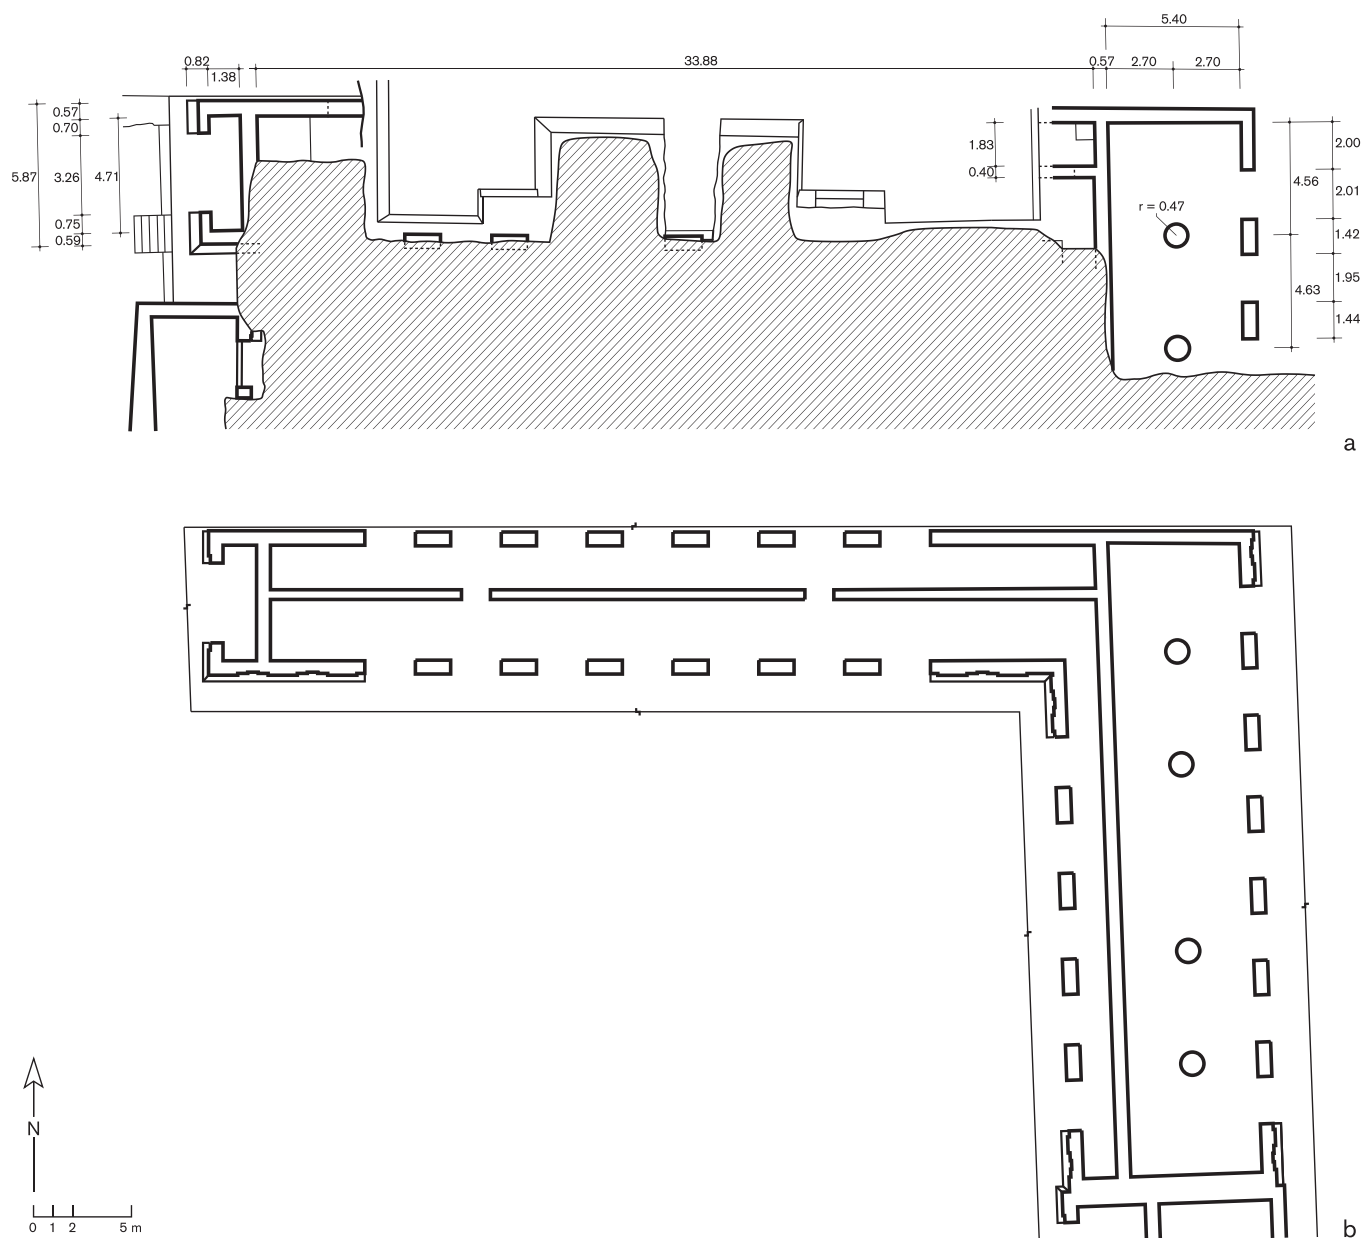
Edificio de las Columnas, planta actual (a) y reconstrucción hipotética C2 (b).
